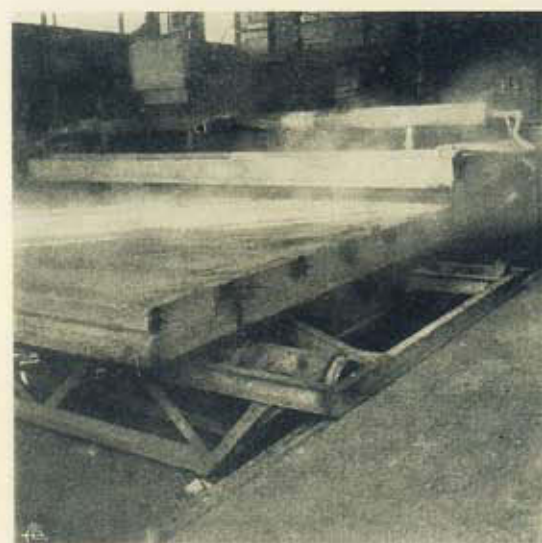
Um elemento de pavimento depois da secagem, pronto a ser içado.
